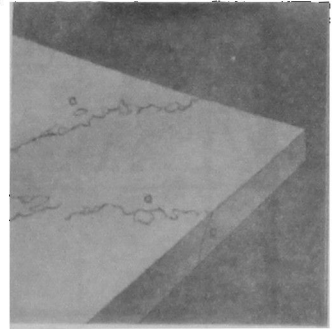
Detalle de esquina de una losa rectangular simplemente apoyada en sus cuatro lados, cargada hasta la rotura. Obsérvese el aplastamiento del hormigón en (a) y la grieta de tracción diagonal (c). Ensayos del IRABA²⁰.
